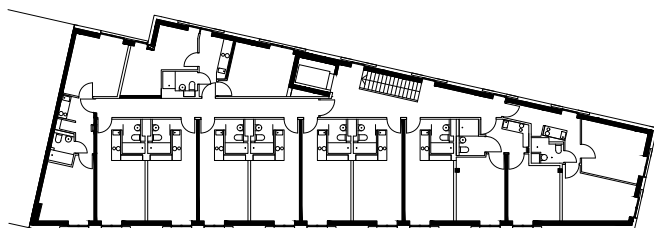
Grundriss Regelgeschoss, M. 1:500 [Quelle: BF Vario]
